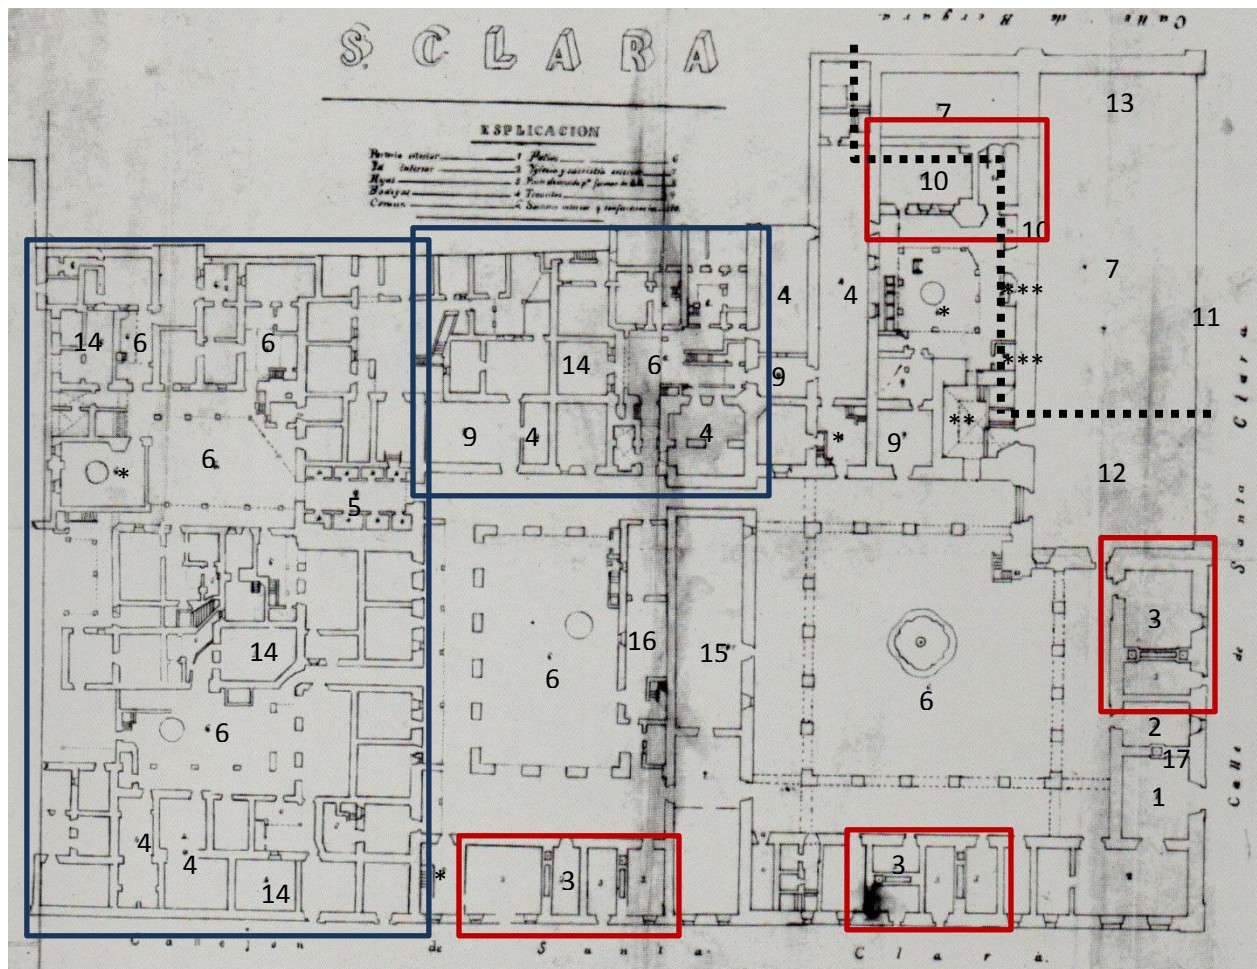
Plano de planta baja del Convento de Santa Clara, hacia 1861. Fuente: Guillermo Tovar, *La ciudad de los palacios...
